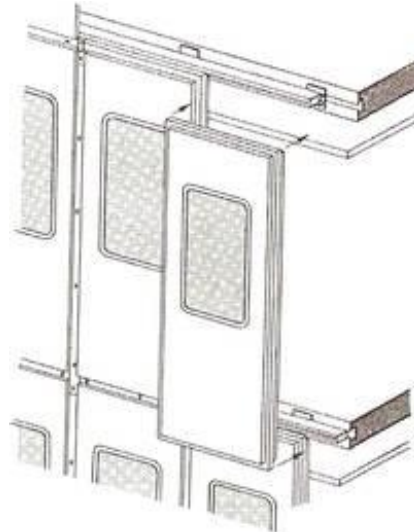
Façade en panneaux préfabriqués, installés directement sans profils porteurs et raidisseurs.
